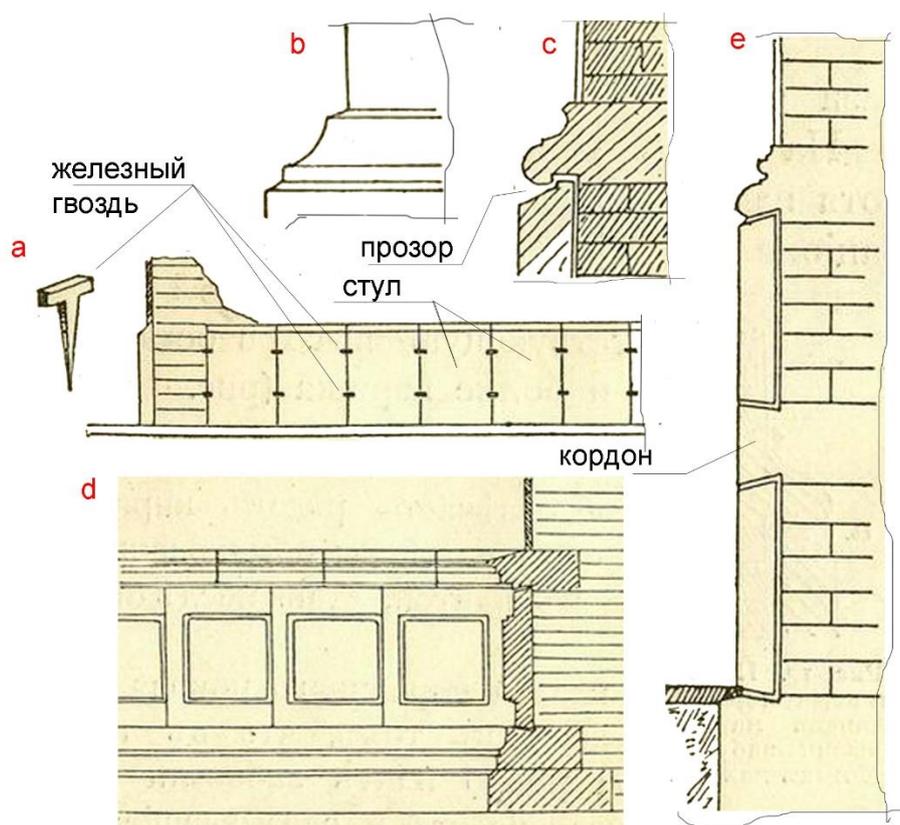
Кордонная кладка цоколя: а – отделка цоколя плитами с креплением к забутовке гвоздями; б – деталь штукатурного слива; с – прозор между камнями кордонной кладки; д – рустованный кордонный цоколь с закреплением вертикальной плиты-стула поясами-кордонами; е – кордонная облицовка двумя рядами поит и поясов [32]
